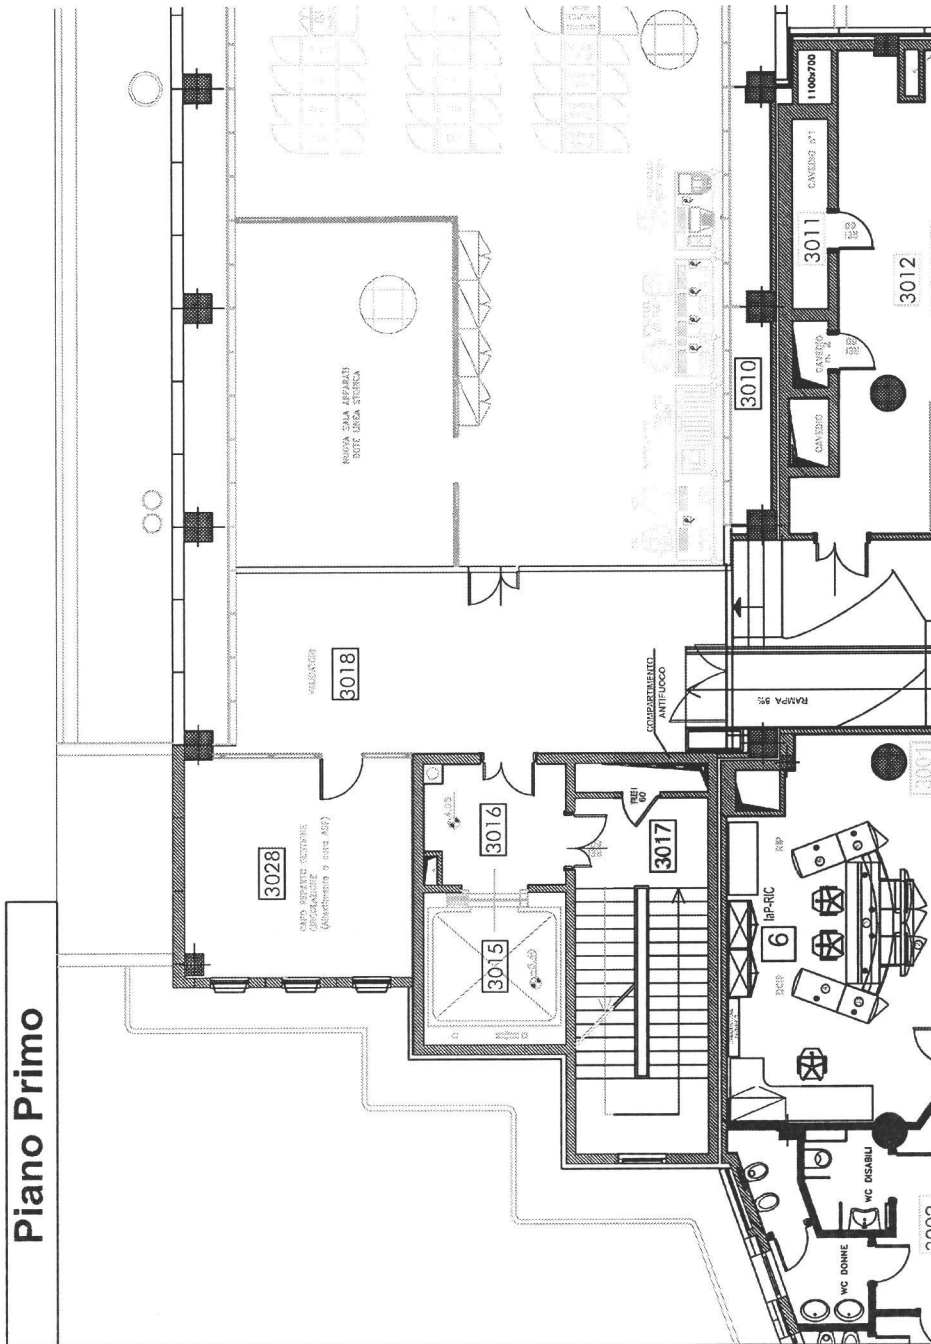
“ Layout edificio DOTE – Primo Piano ”
